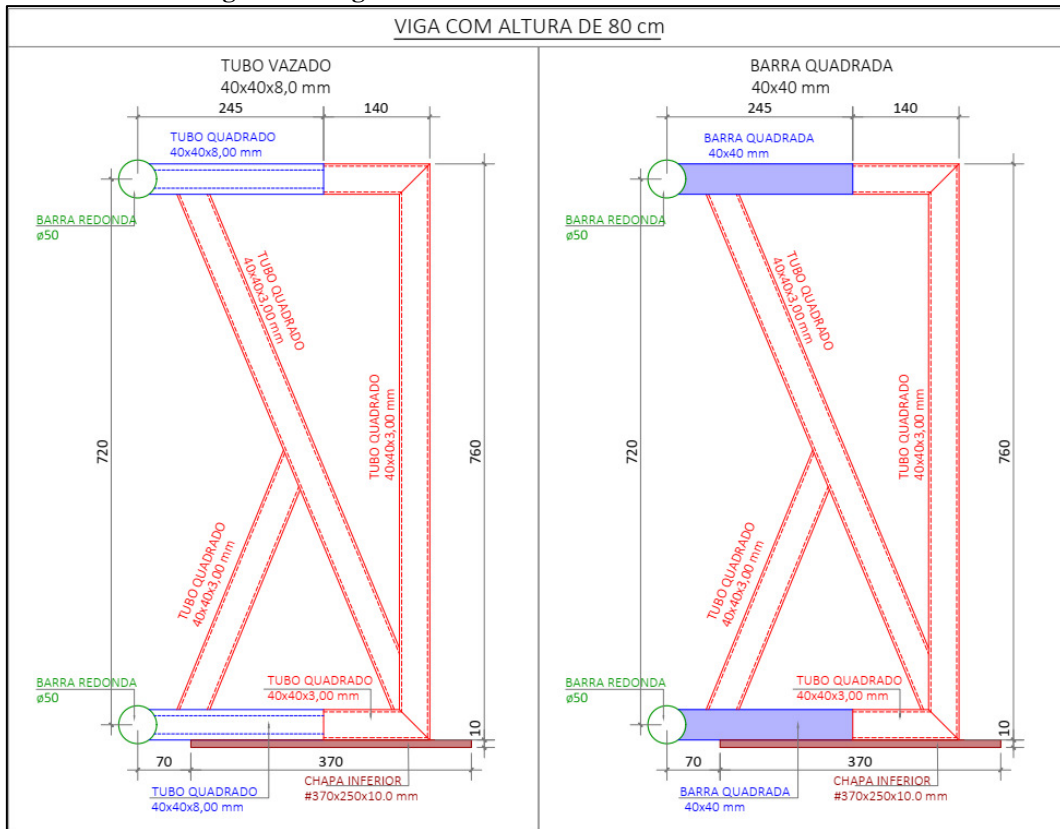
Viga 30x80 - Tubos e barras metálicas 60 mm
